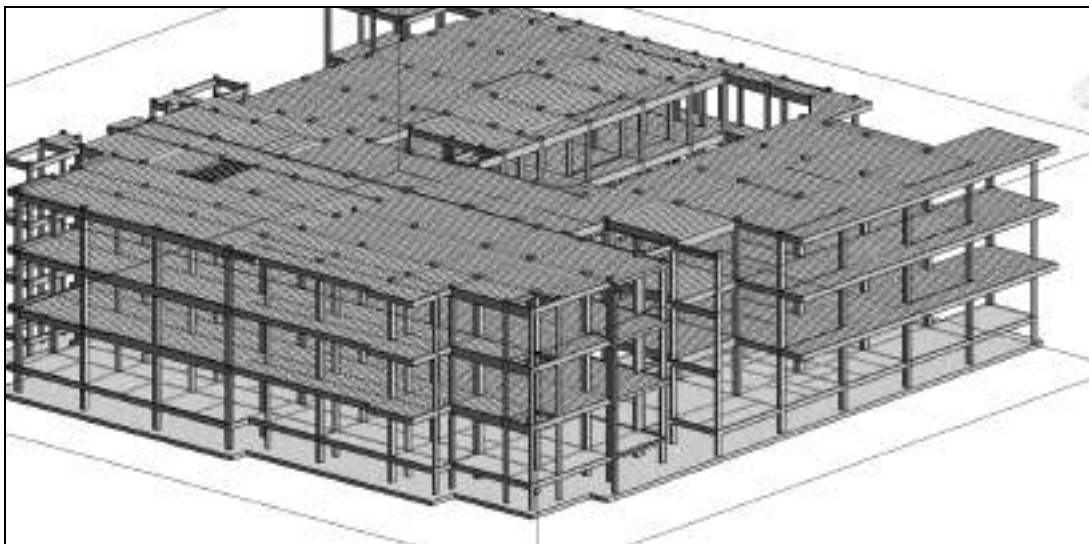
Autodesk Revit -Vista 3D Modelo estructural del edificio hasta último piso.
